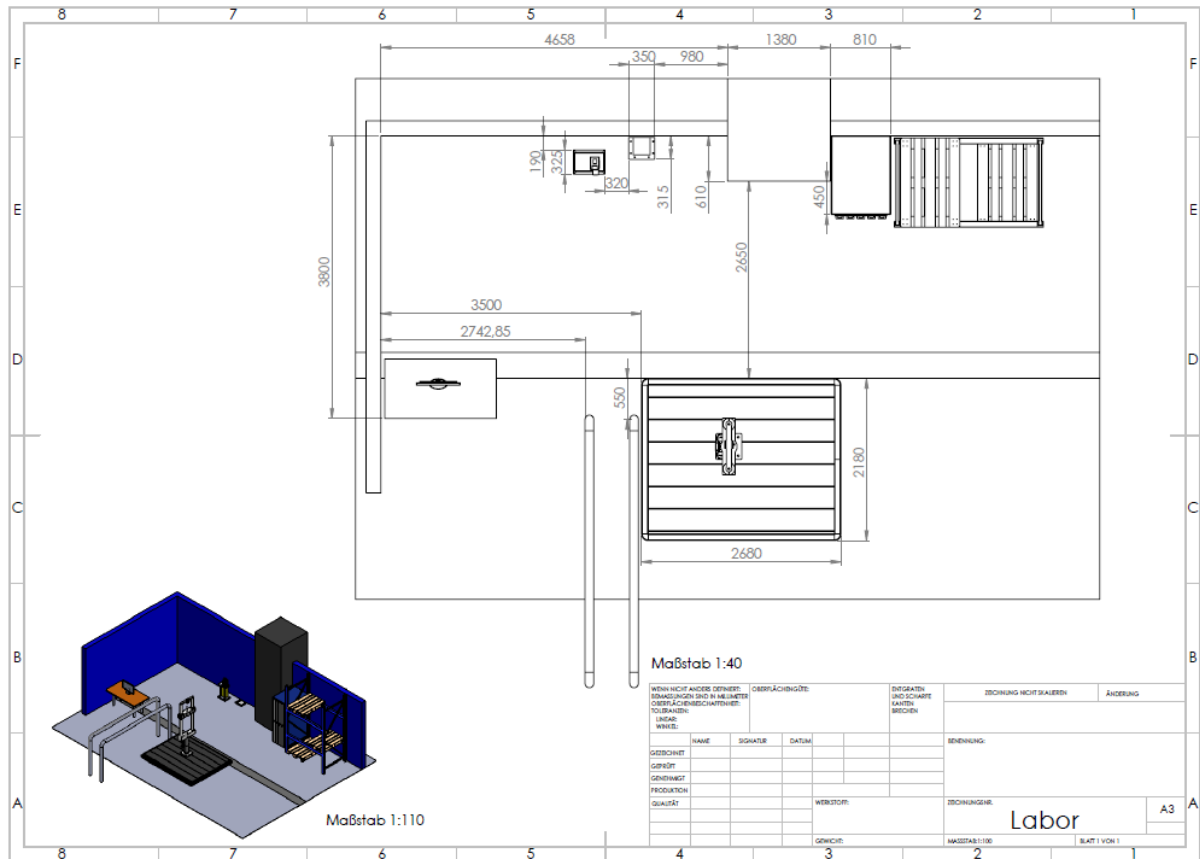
Grundriss Labor mit Laborschrank und Workstation
